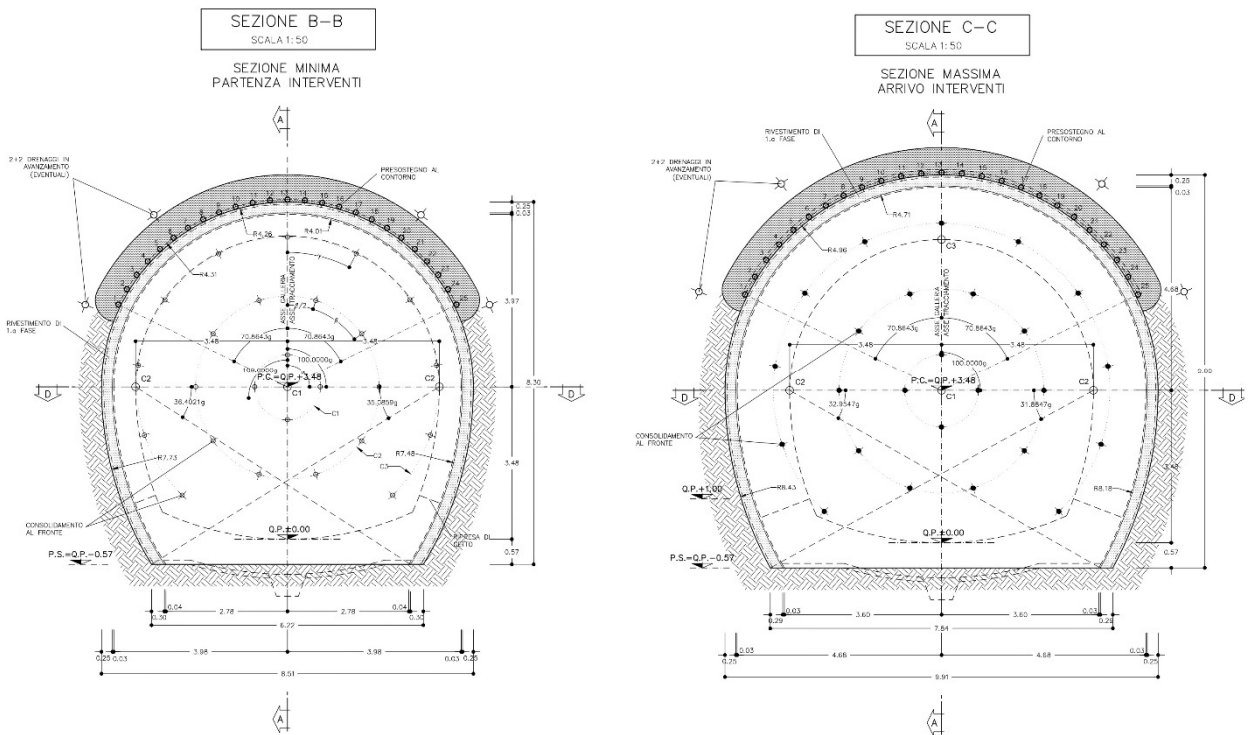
Sezione Tipo B2V\* – Scavi e consolidamenti - Sezione
